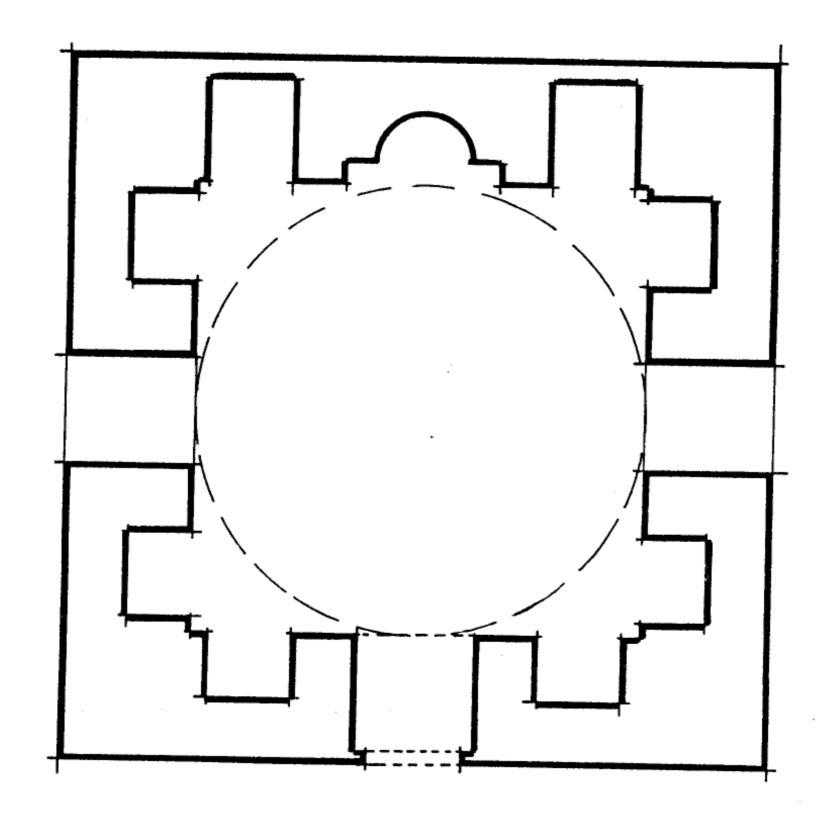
مسقط أفقسى لقبسة الأمير سليمان (مقياس الرسم ١ / ٠ ٥)
